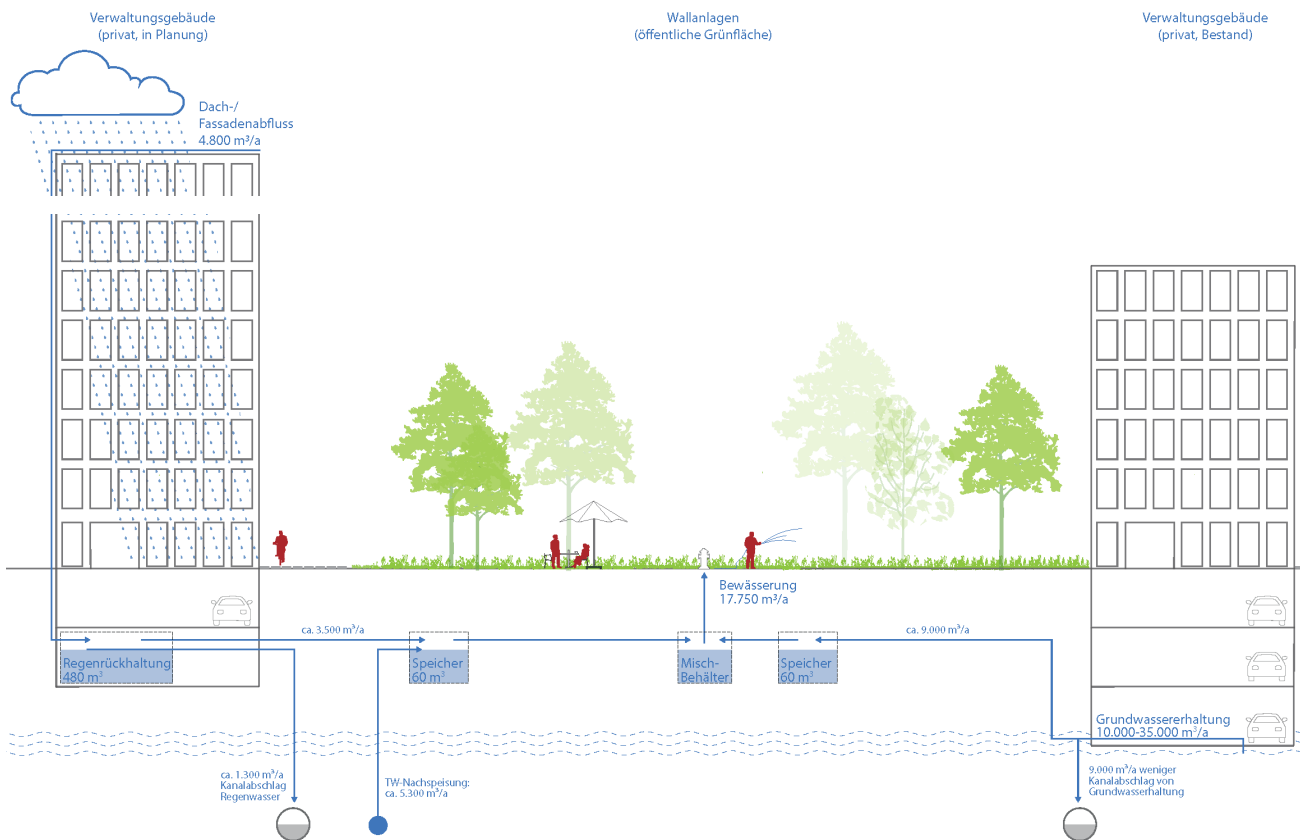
Soll-Zustand: Kombinierte Nutzung von Drainagewasser aus einer ständigen Grundwassererhaltung mit Niederschlagswasser von Dach- und Fassadenflächen mit dem Ziel der Bereitstellung von Bewässerungswasser (Berechnungsbeispiel für 25.000 m³/a Drainagewasseranfall).
